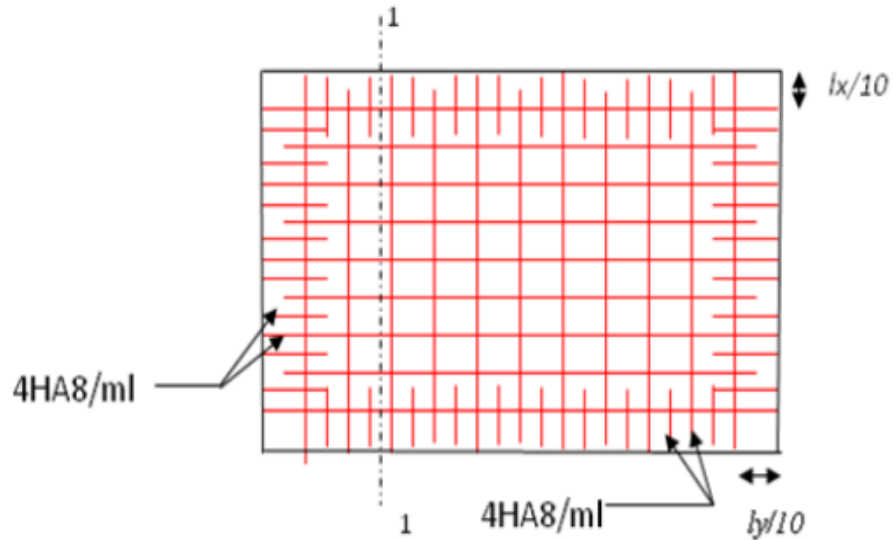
Schéma de ferrailage de la dalle (vue de face).
